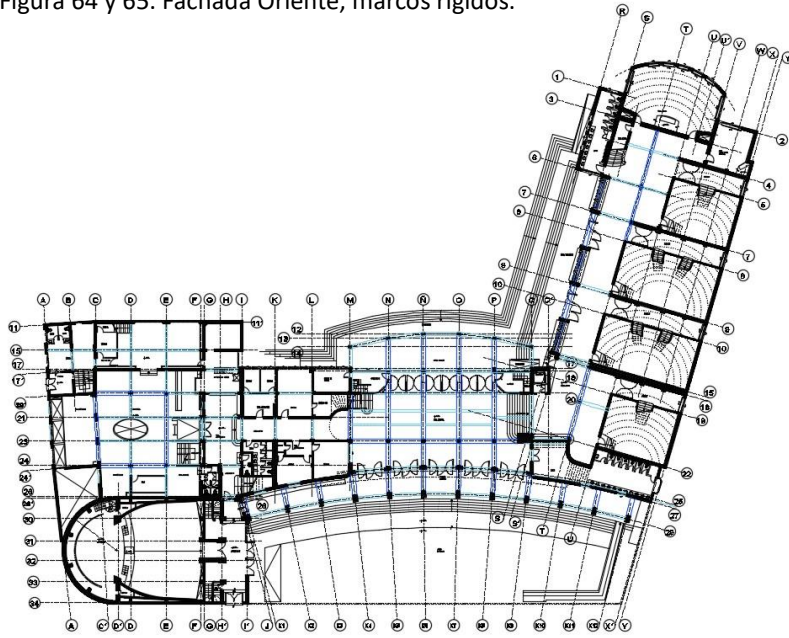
Planta Primer piso, marcos rígidos, esquema estructural, creación propia.
